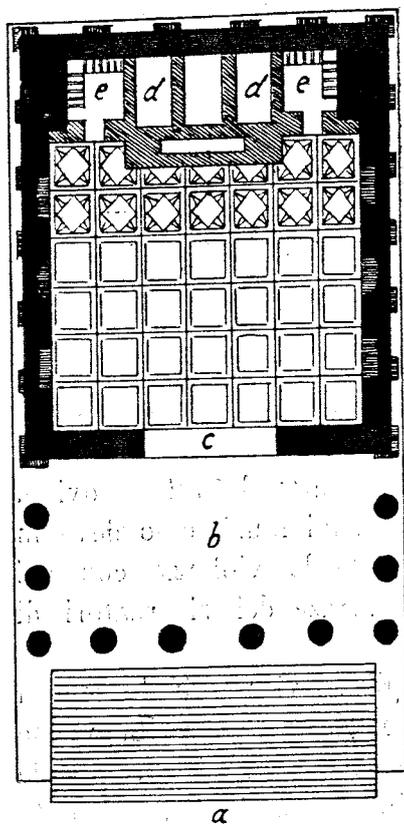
Piantina del tempio detto di Vulcano eseguita nel 1804.
